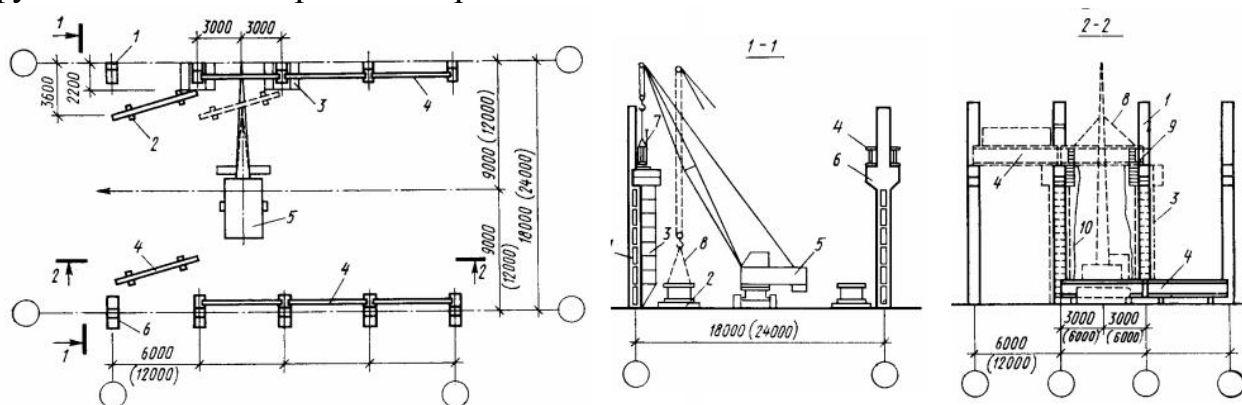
Схема выгрузки и раскладки подкрановых балок пролётом 12 и 18 м: 1 – колонна крайнего ряда; 2 - деревянная прокладка; 3 – приставная лестница; 4 – подкрановая балка; 5 - автомобильный кран; 6 – колонна среднего ряда; 7 – оттяжка из пенькового каната; 8 – строп.
